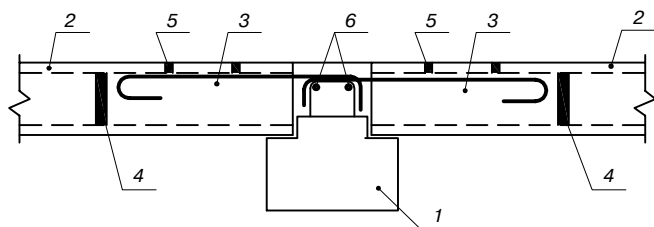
Узел 2. Опирание плит перекрытия на ригель: 1 – сборный железобетонный ригель; 2 – железобетонная пустотная плита перекрытия; 3 – анкерующий стержень; 4 – заглушка; 5 – отверстие для контроля заполнения пустот бетонной смесью; 6 – верхняя арматура ригеля
